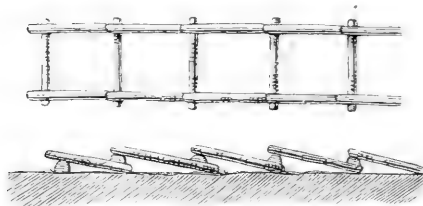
Fußbrücke zum luftigen Schichten des Holzes.
